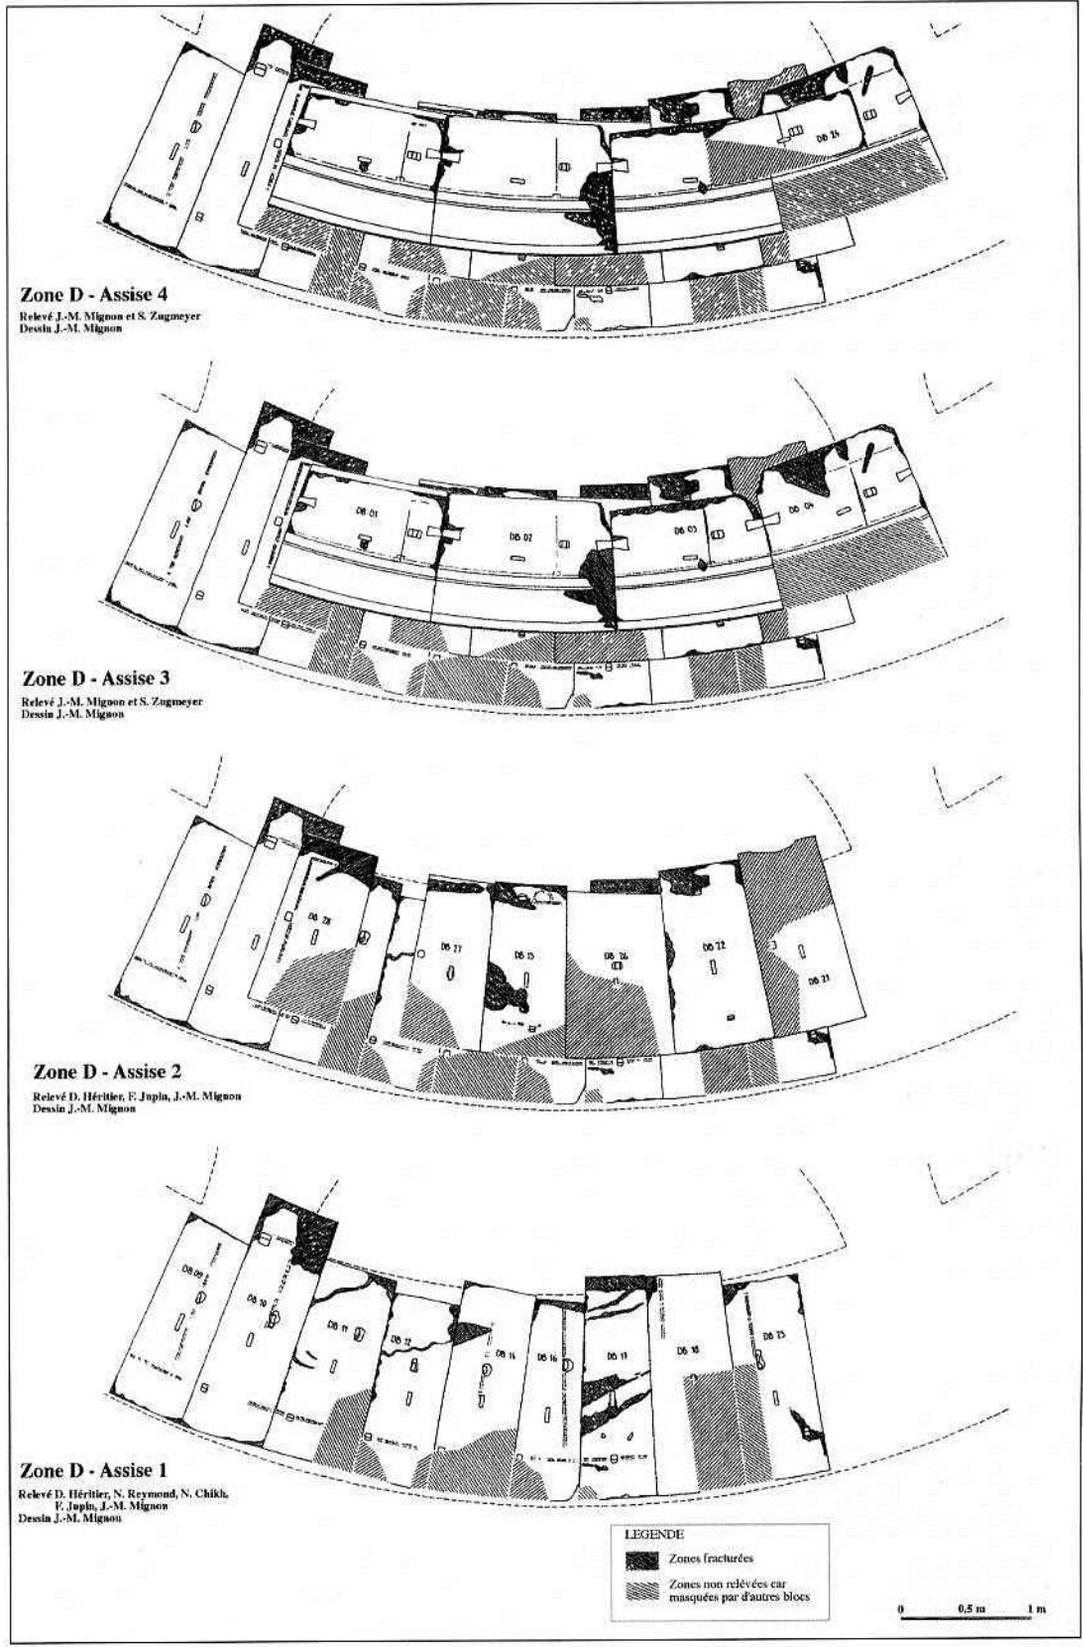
Plans d'assemblage des assises 1, 2, 3 et 4 du mausolée D.
